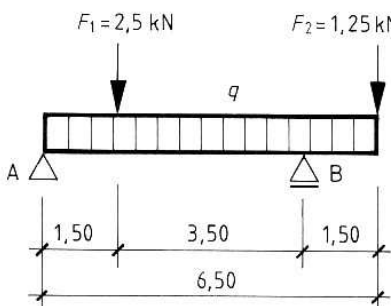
/6: Kragträger mit Streckenlast und 2 Einzellasten
